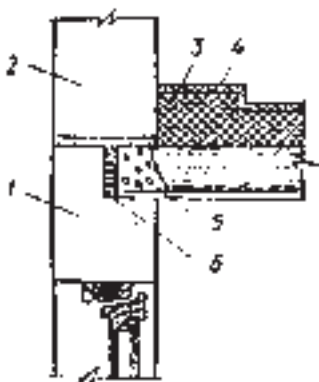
Утеплення горючого перекриття на приляганні до стіни.
